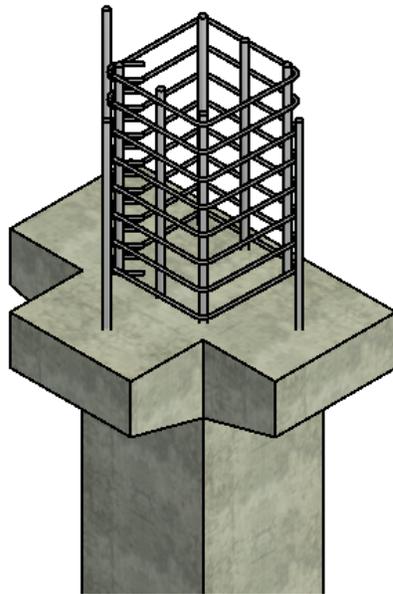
Pilar central con aceros en espera, incluyendo pivote de recepción. Fuente: Elaboración propia.
